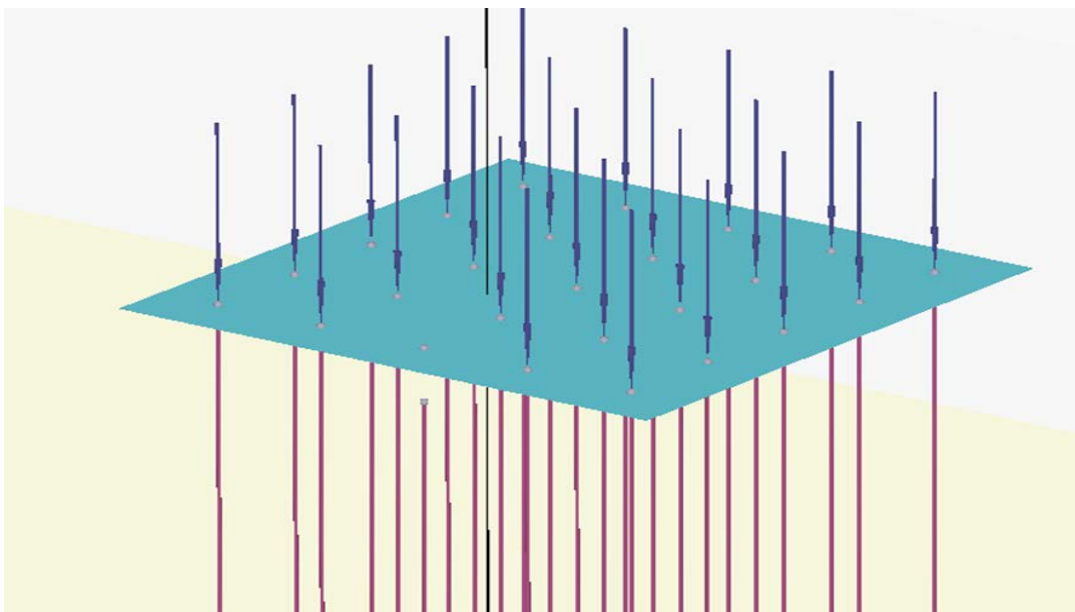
Общий вид расчетной схемы на этапе моделирования испытания свай
